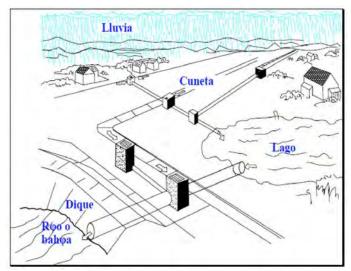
Sistema de alcantarillado pluvial (CNA, 2013).
